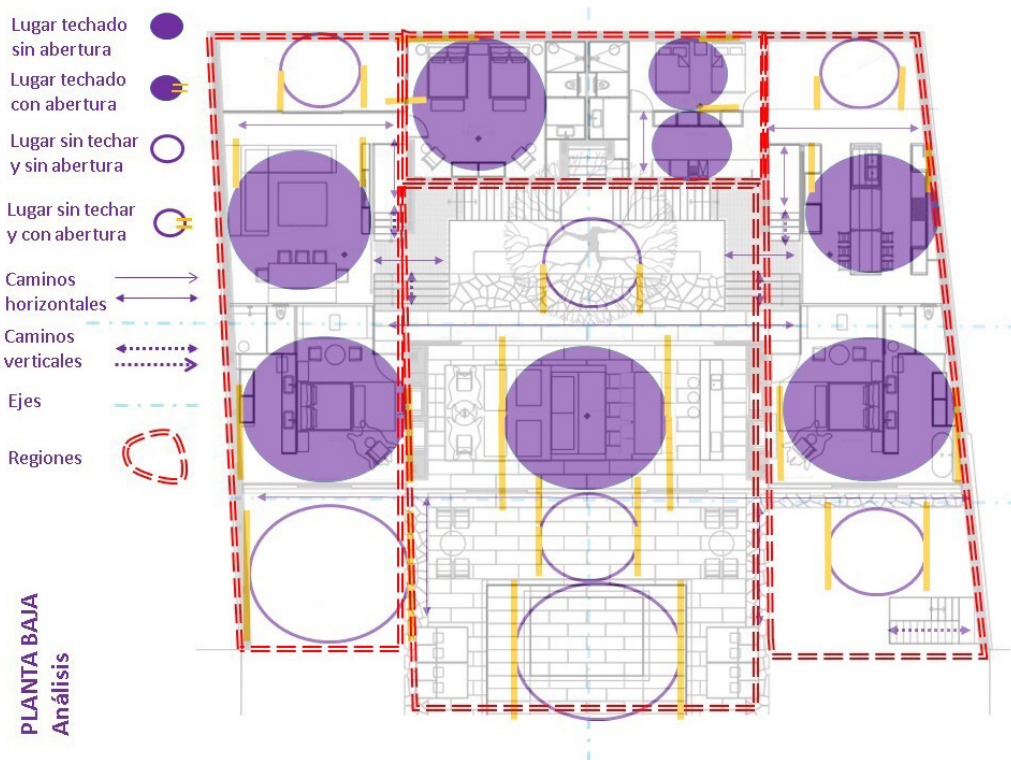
Análisis de planta baja. Plano base del archivo de Mónica Ledezma. Reproducida con permiso de la autora Mondragón Ruiz (2023).
